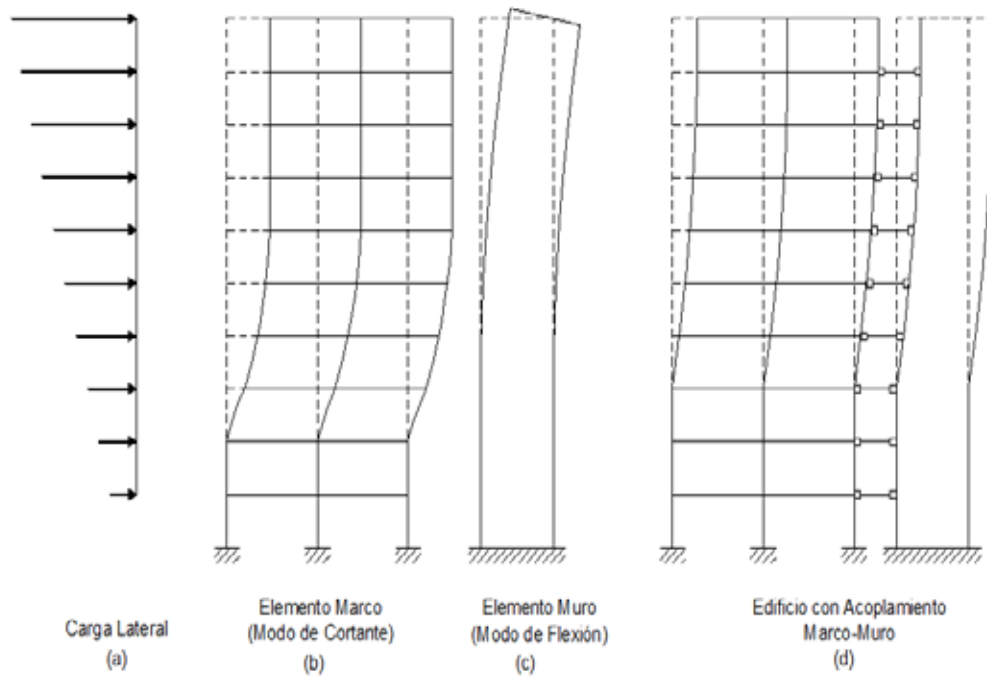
Deformación ante cargas laterales de un pórtico, un muro y un sistema dual.
